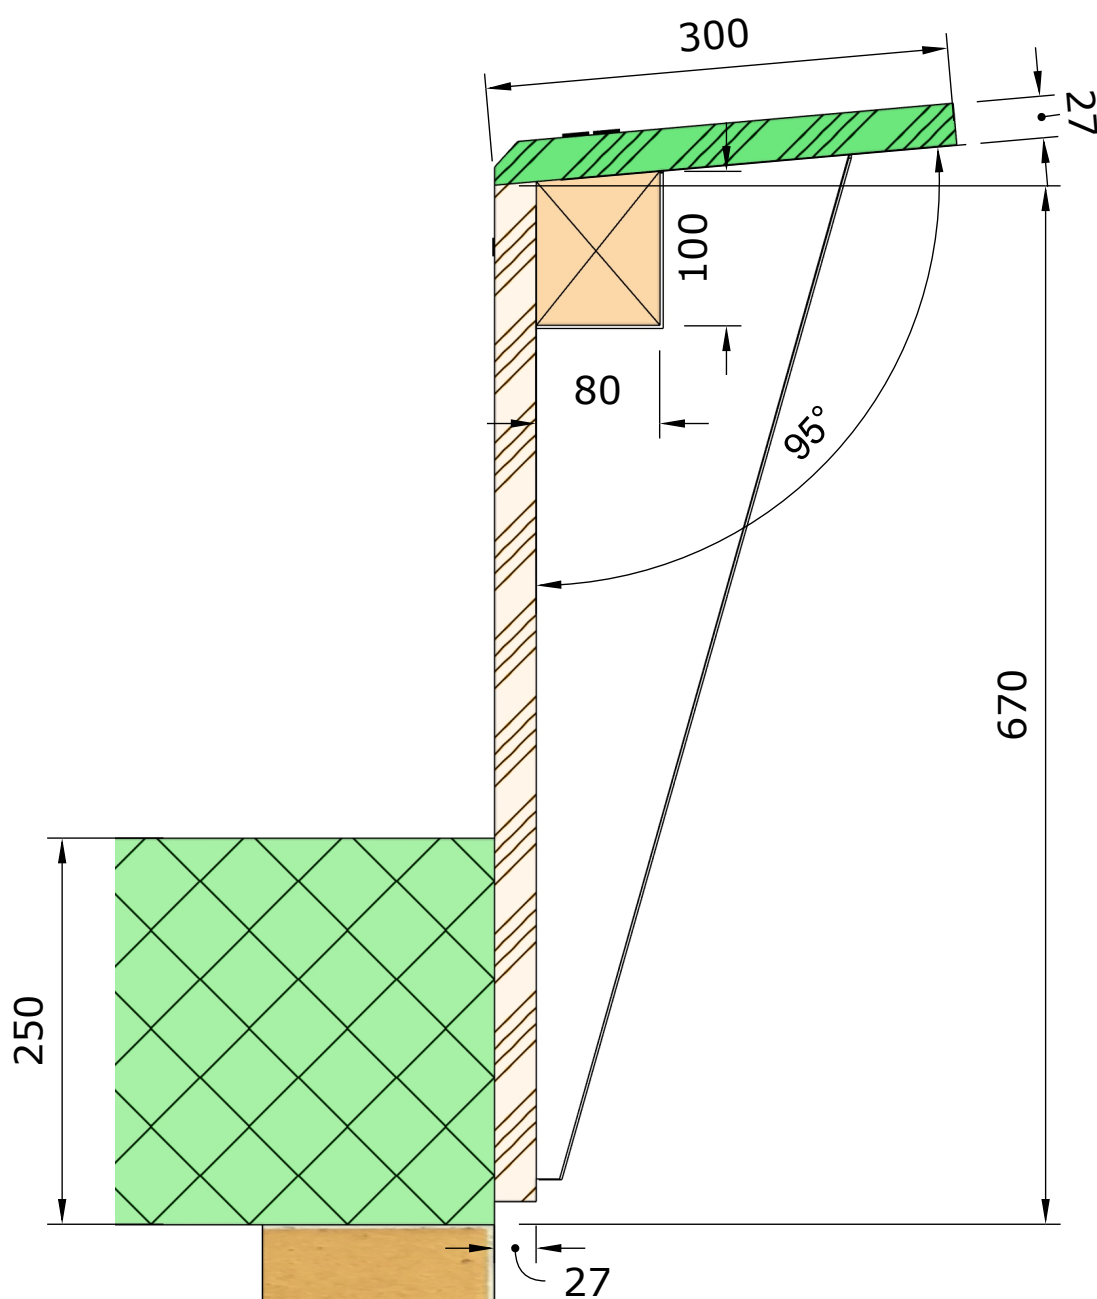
Ansicht Schnitt, vollständig begehbare Dachrandkonstruktion mit durchlaufenden Vollholzbalken 80 x 100 mm mit ausgeklinkten Stützblechen.
